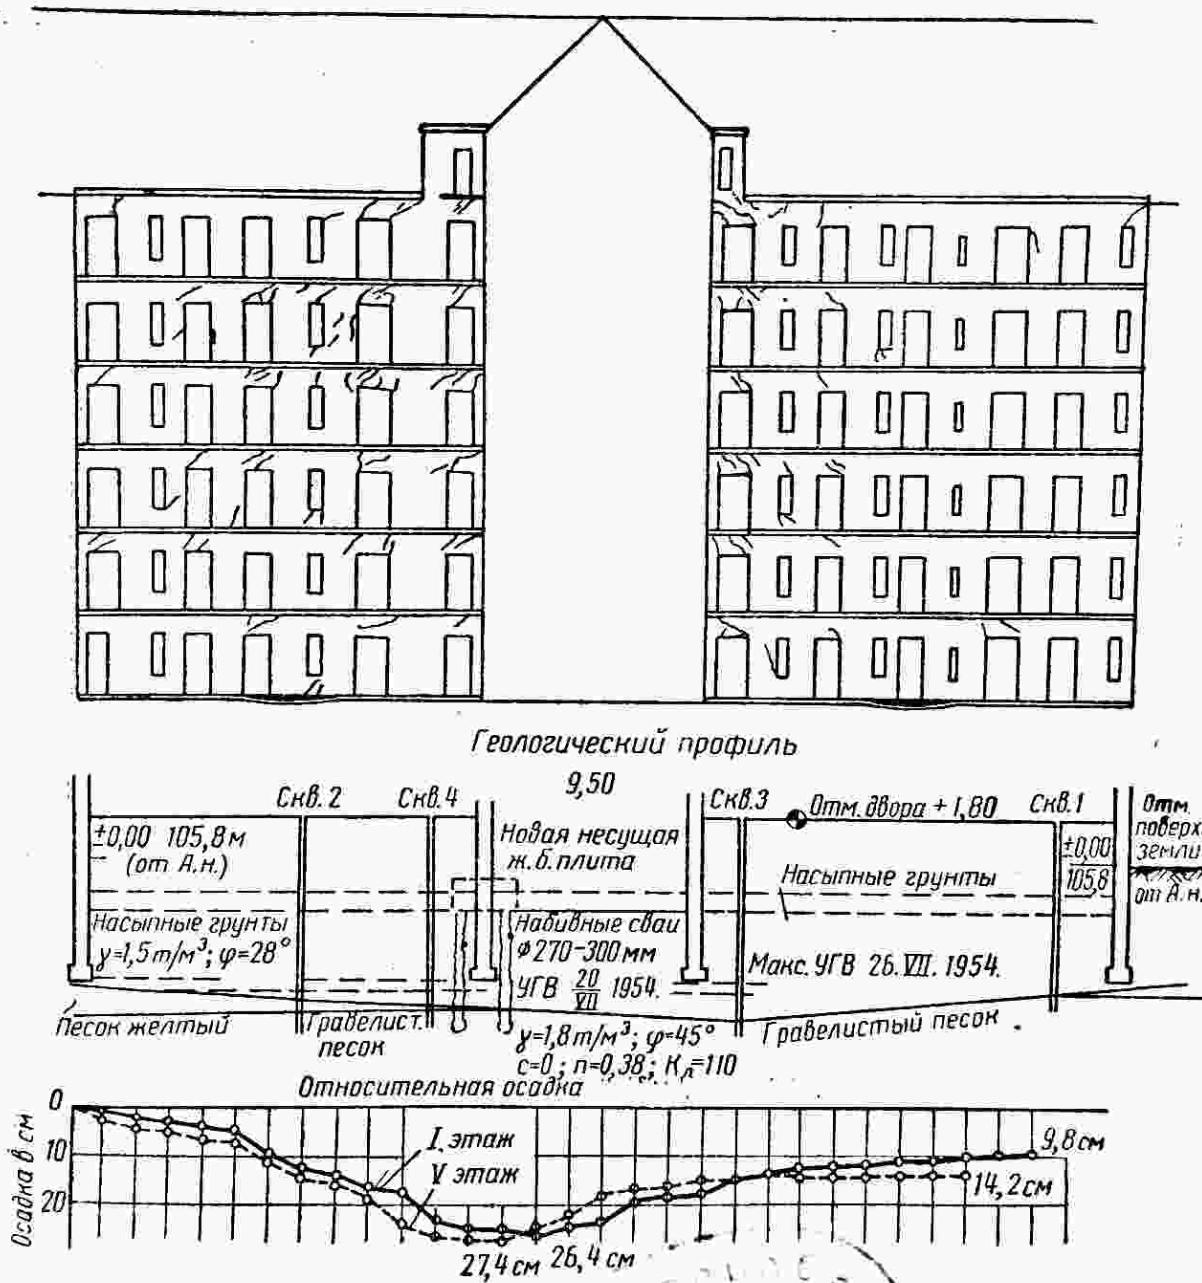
Разрез жилого дома на проспекте Шорокшари
